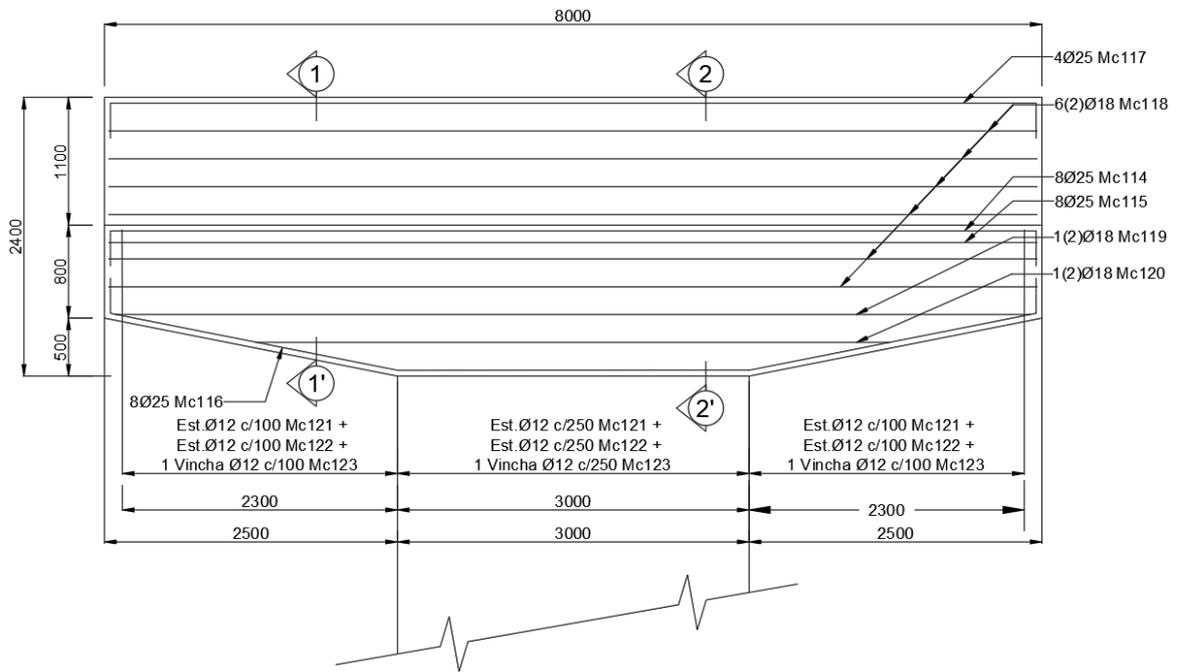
Armado de la viga cabezal [Elaboración propia]
